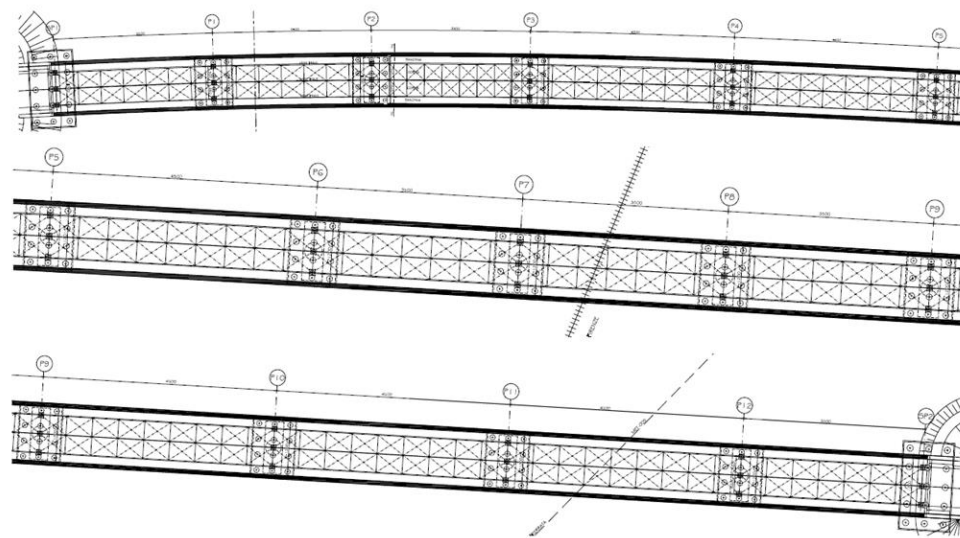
Cavalcaferrovia Frizzone: pianta impalcato
